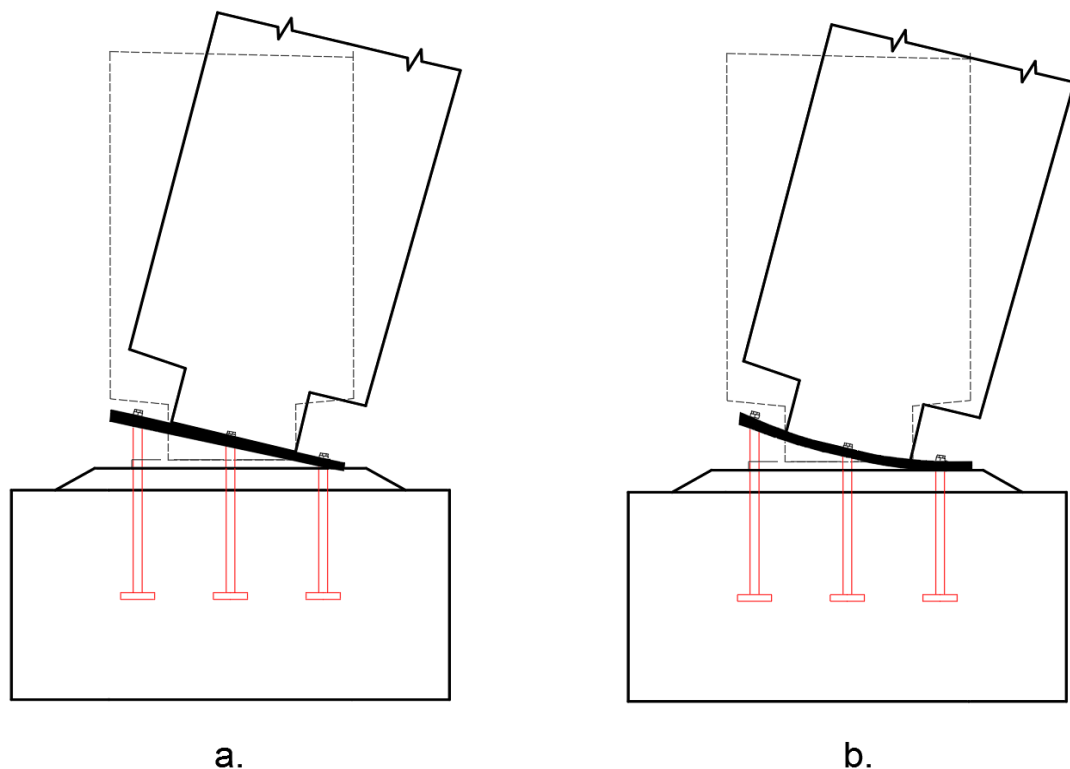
a. Giro con placa de anclaje rígida b. Giro con placa de anclaje elástica
